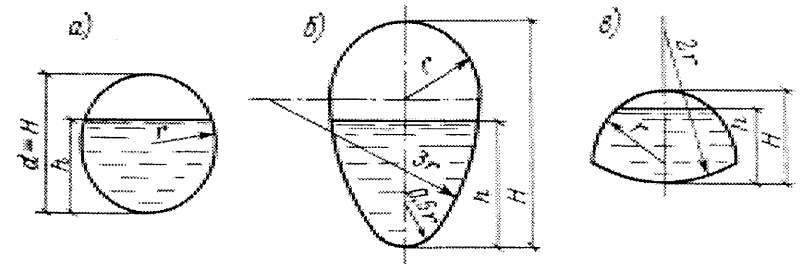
Формы поперечных сечений безнапорных трубопроводов а — круглое; б — овоидальное; в — лотковое
